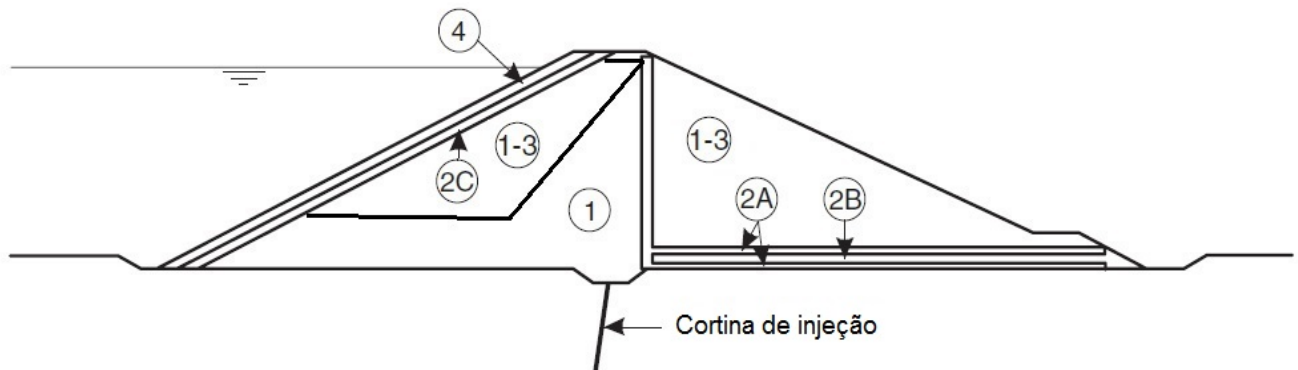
Barragem de terra zoneada com filtro vertical e tapete horizontal
